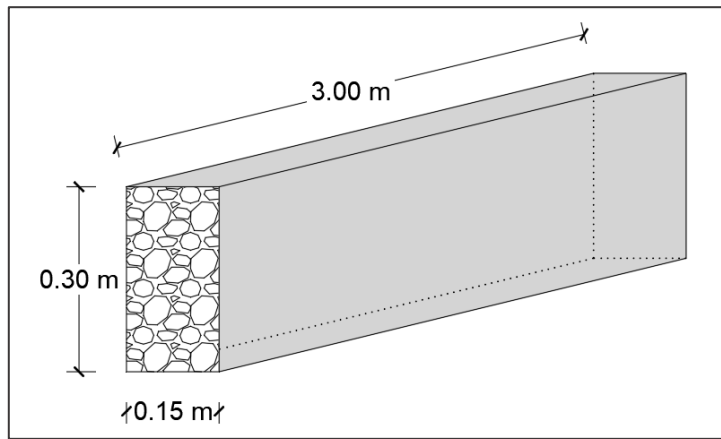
Predimensionamiento de la viga según ACI 318, Fuente: Elaboración Propia.
